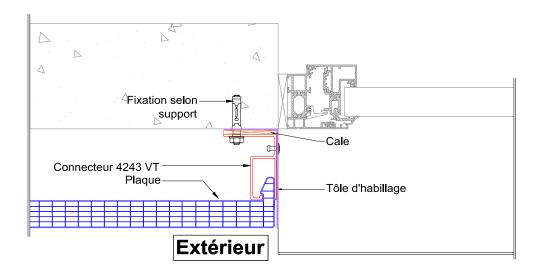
Encadrement d'une baie en tunnel - Coupe horizontale
